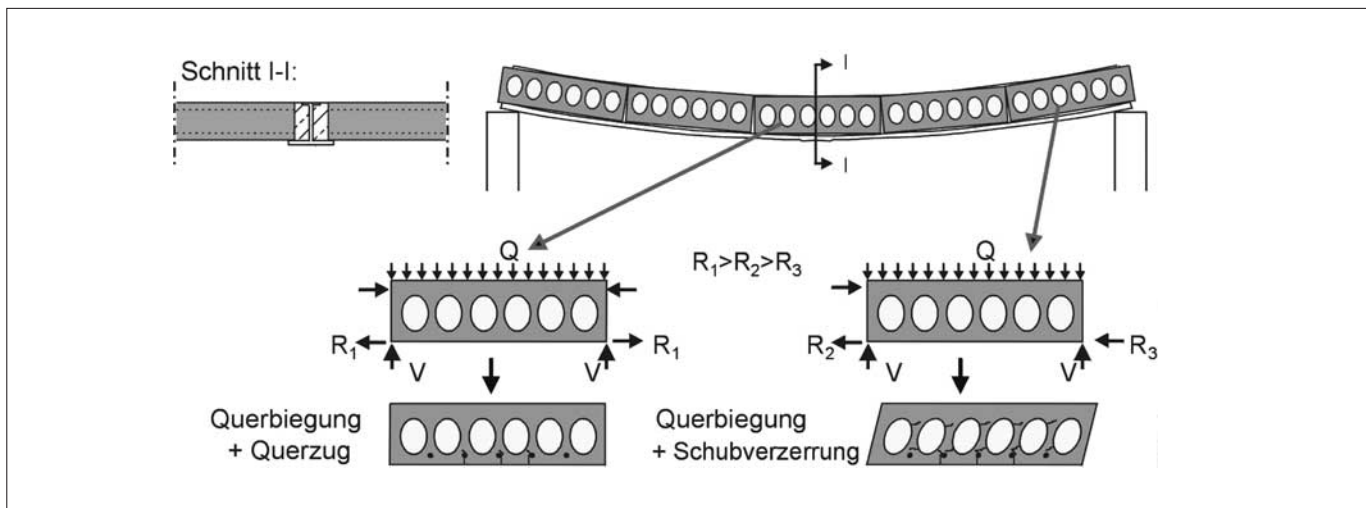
Spannbeton-Fertigdecken bei Auflagerung auf deckengleichen Stahlträgern
